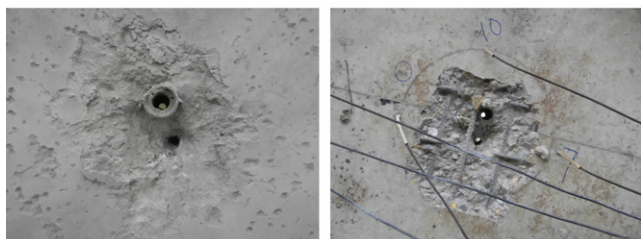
钢筋混凝土靶板初始状态与失效战斗部撞击靶板
